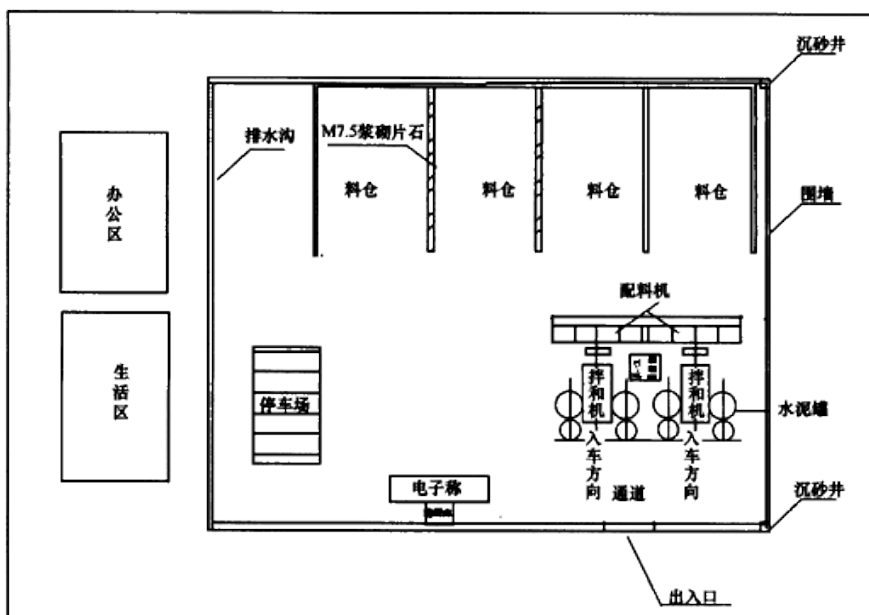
B420163-1 某水泥混凝土拌和站平面布置示意图
